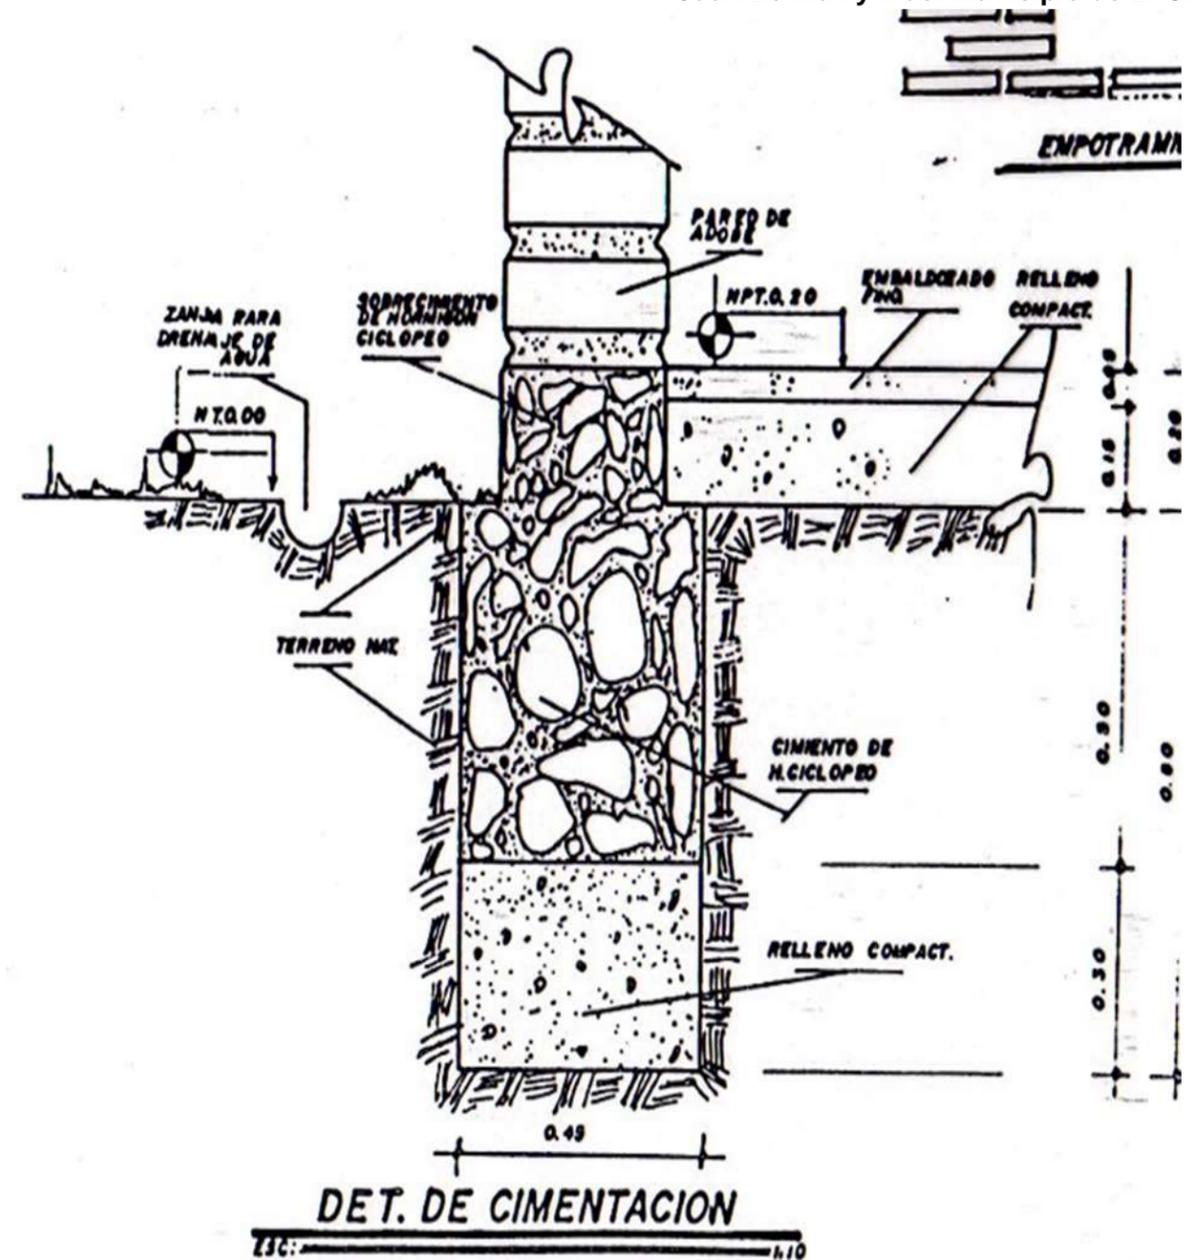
Detalle de Cimentación Fuente: Arq. Federico Matus Vega.
